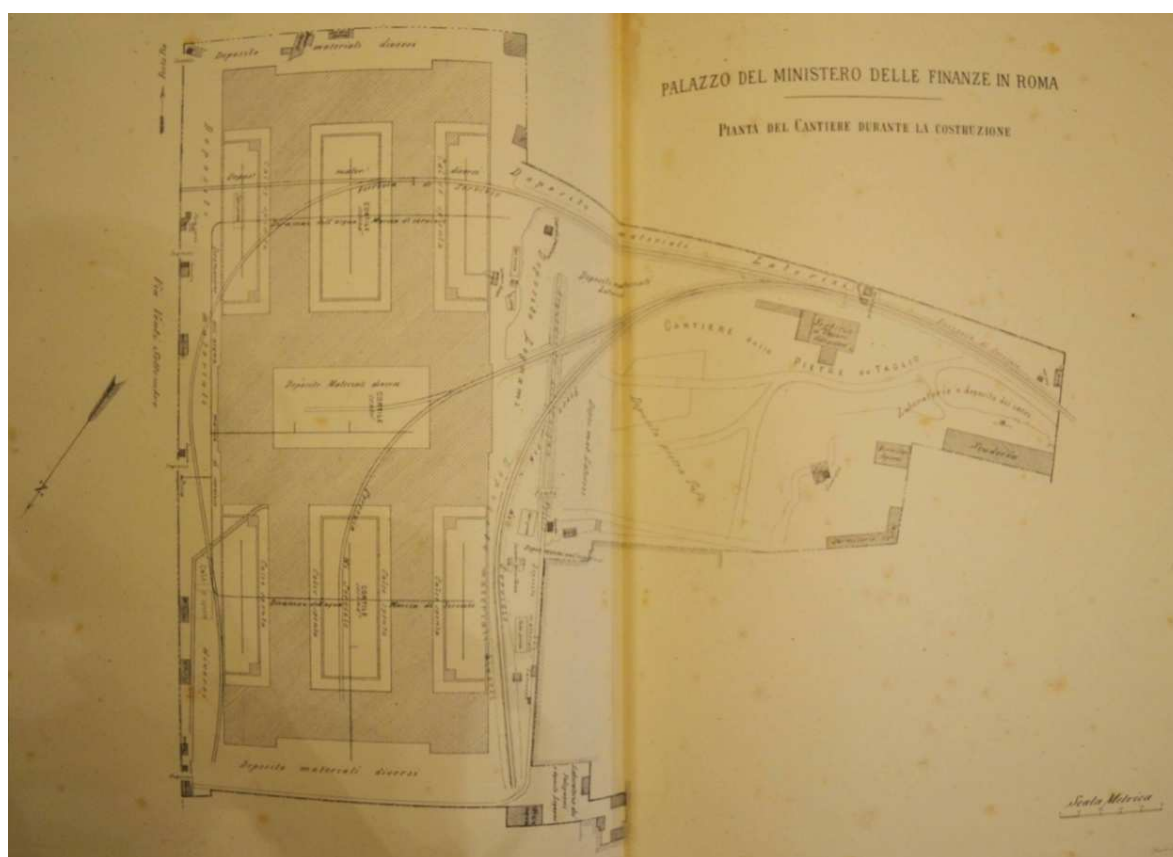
Pianta del cantiere di costruzione con definizione del binario interno (SOCIETÀ VENETA 1881, tav. IV)
